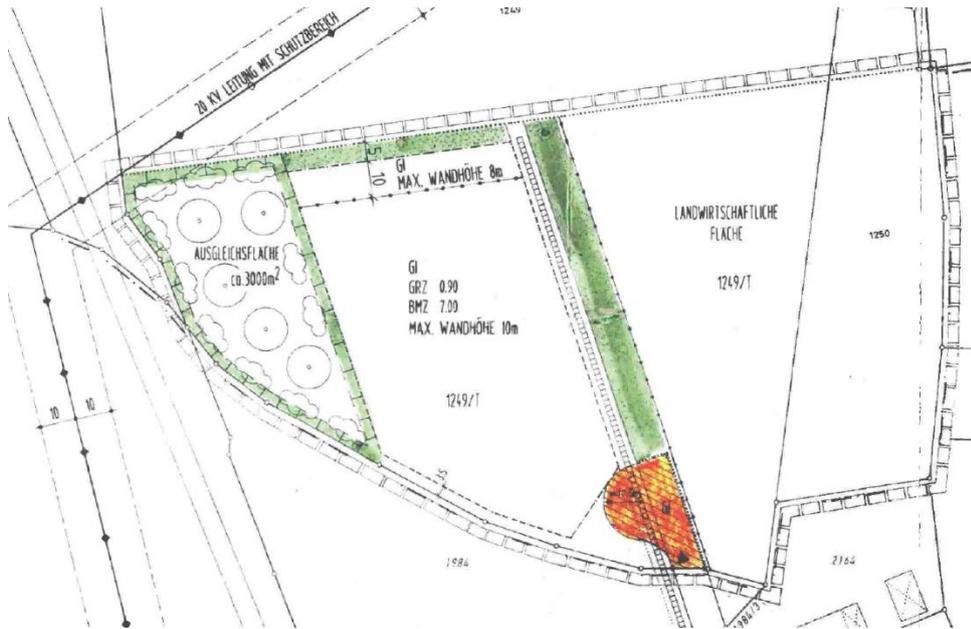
rechtsverbindlicher Bebauungsplan vom 12.12.2002
